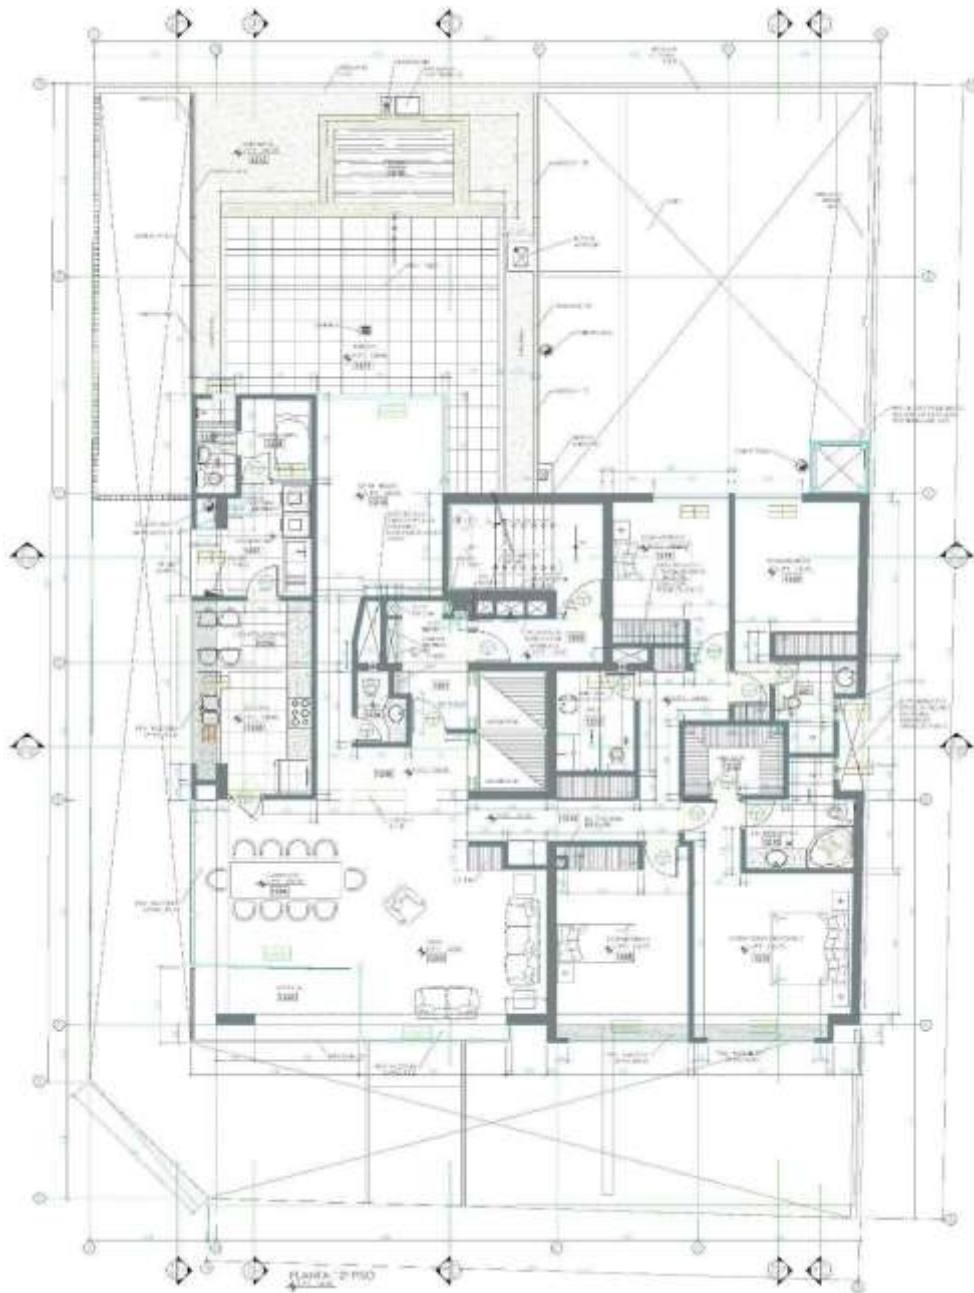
Planta de 3°, 5°, 7°, 9° y 11° piso – Arquitectura
